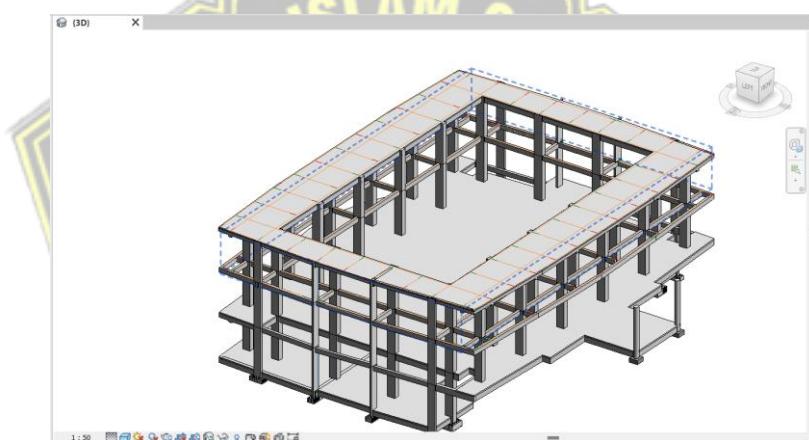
23 Tampilan Pemodelan Balok Lantai 2
